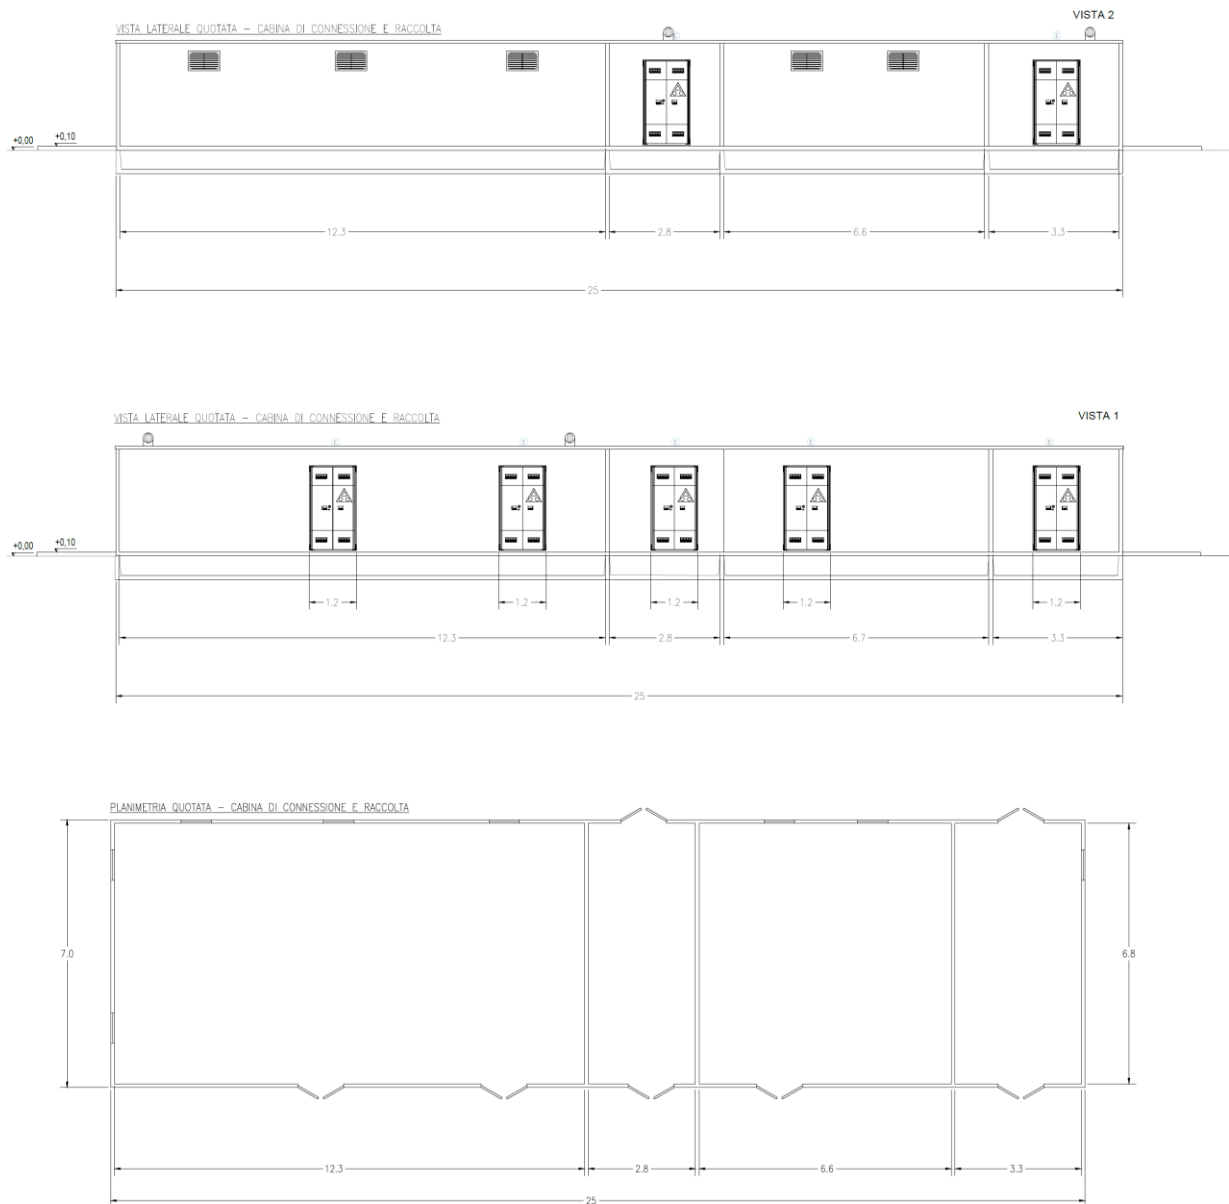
VISTE IN PIANTA E PROSPETTO CABINE DI RACCOLTA
